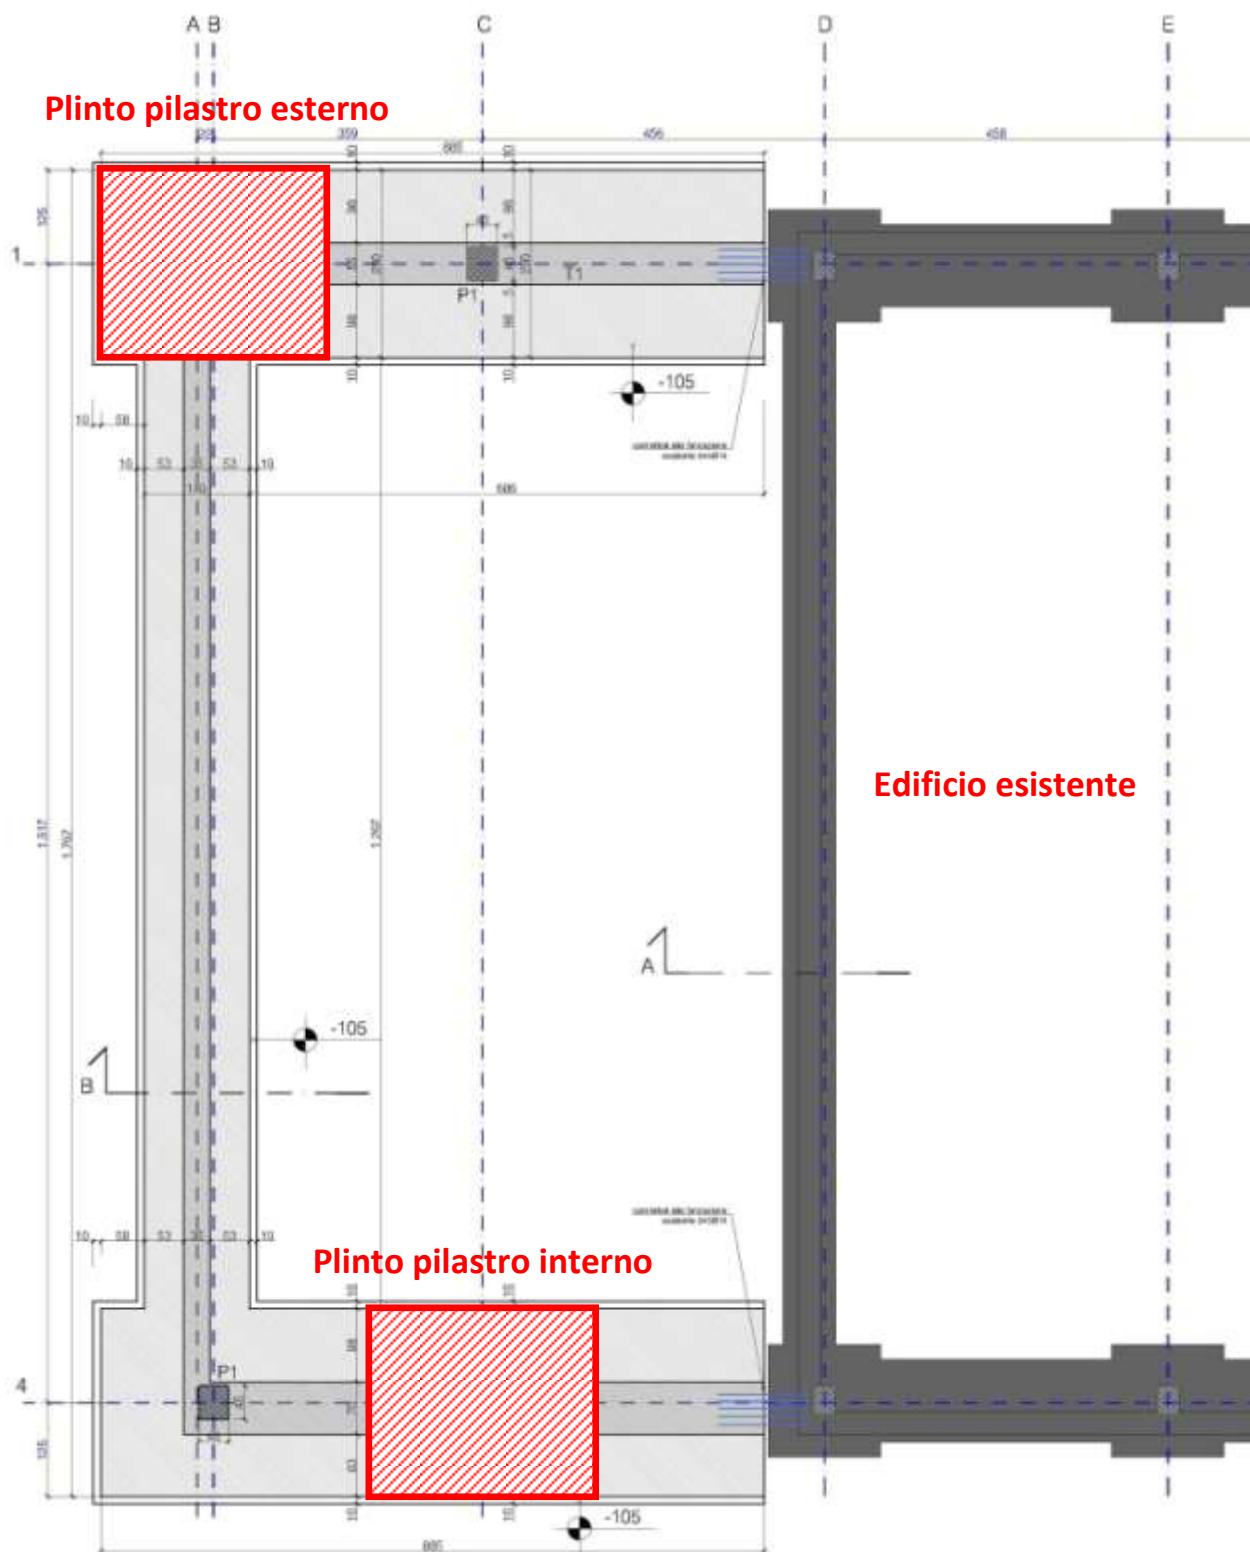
Stralcio della pianta delle fondazioni (tavola S01).
